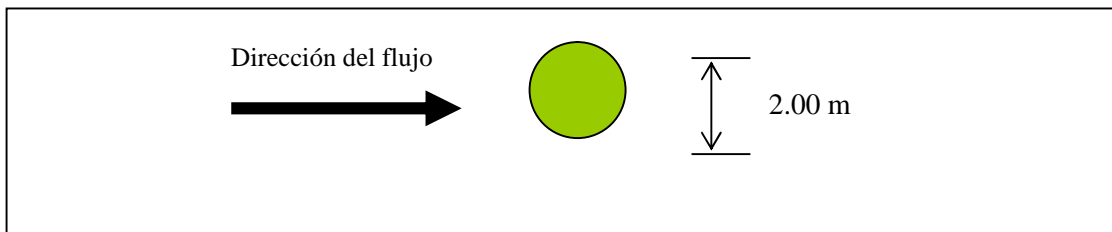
Sección del pilar del Puente Aguas Verdes, carretera Panamericana Norte
